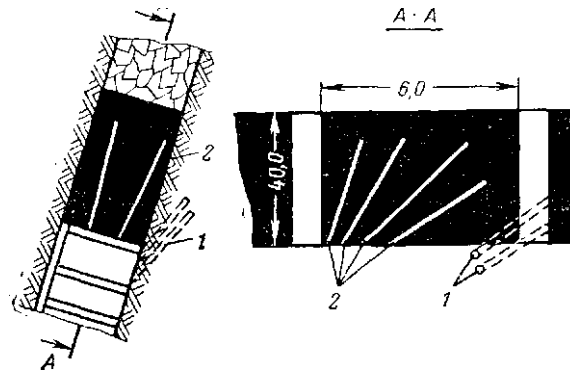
Расположение шпуровых зарядов при перепуске обрушенных пород с верхнего подэтажа в нижний:
